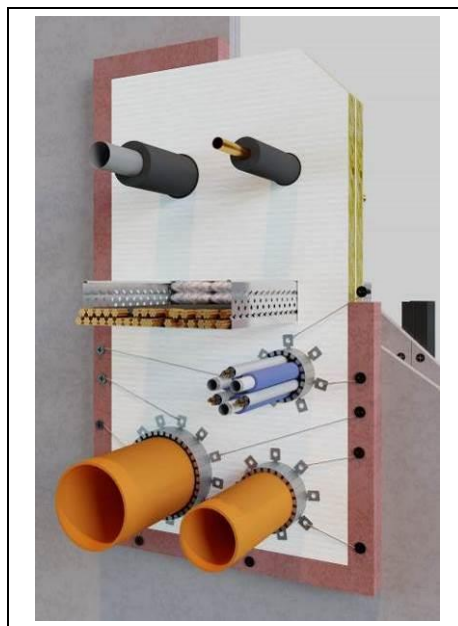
Exemple de joint AF PANEL dans un mur de revêtement EI 60.
